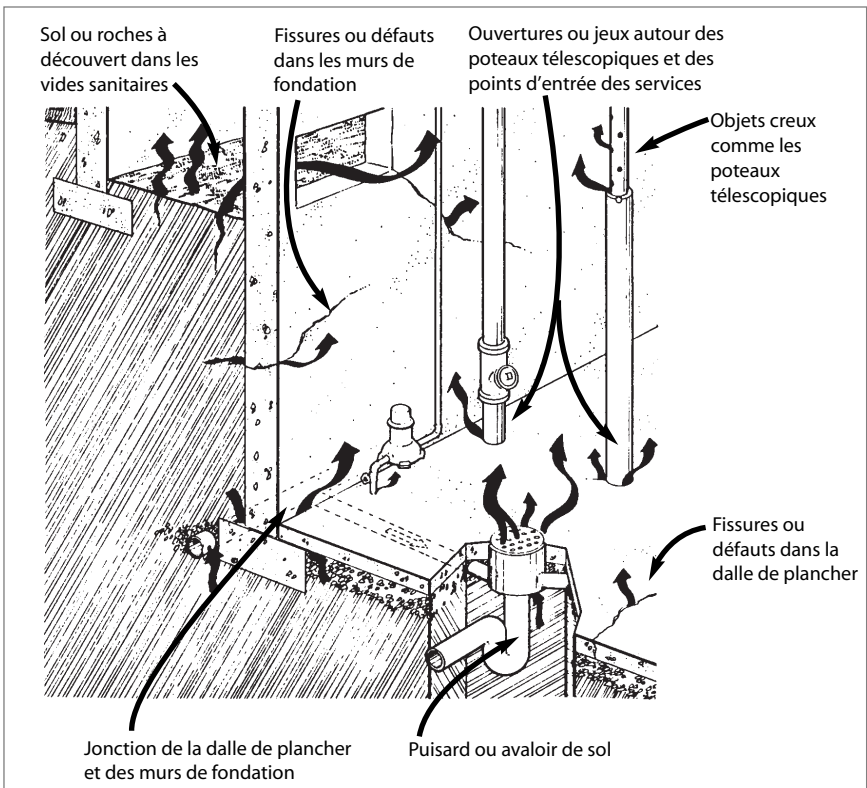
Points d'entrée habituels du radon dans les murs de fondation et les planchers en béton coulé
